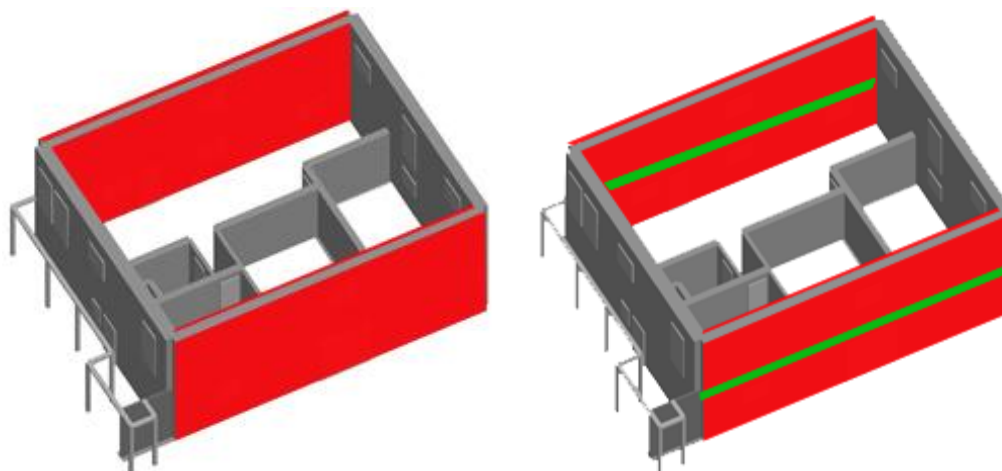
Comparação da execução de reboco armado nas duas faces das fachadas laterais com a solução conjunta de introdução de tirantes ao nível do pavimento do piso 1 e execução de reboco armado nas duas faces das mesmas fachadas
